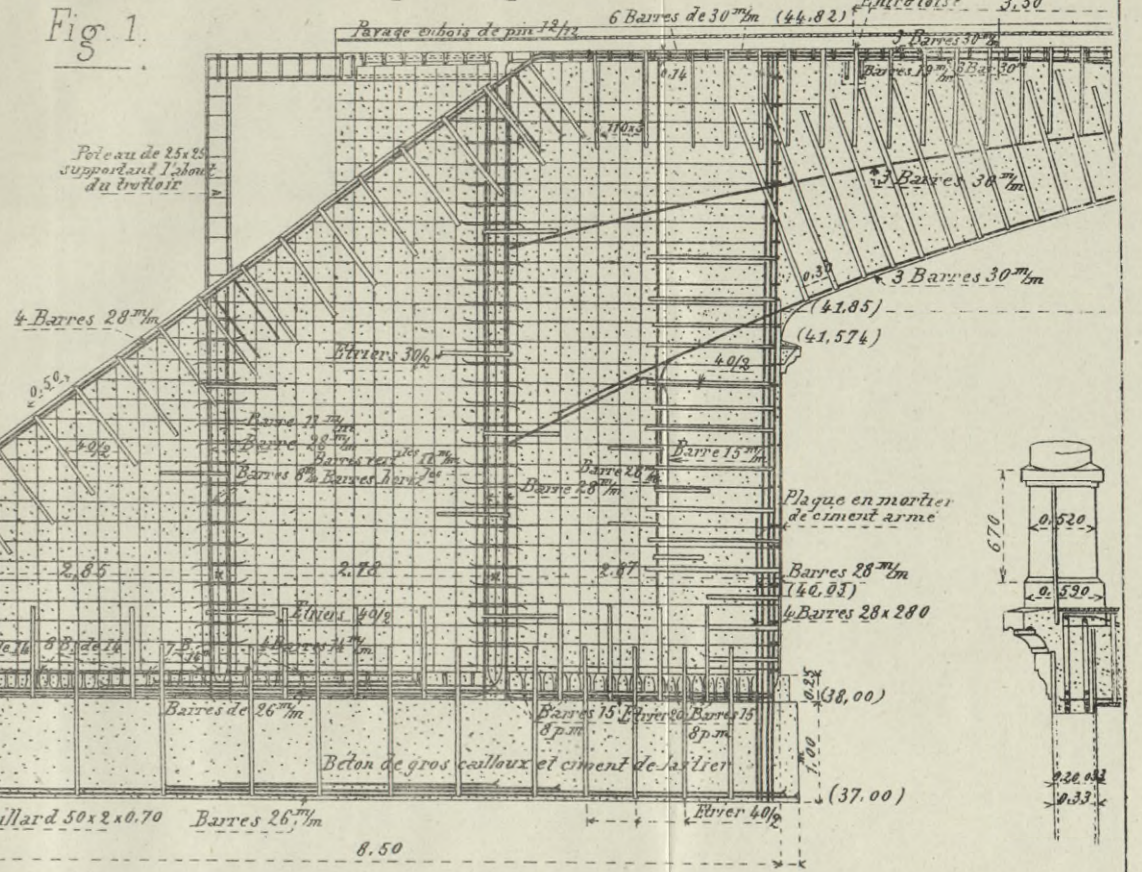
Canal de Bergues.—Pont fixe. Plan de la culée droite.
